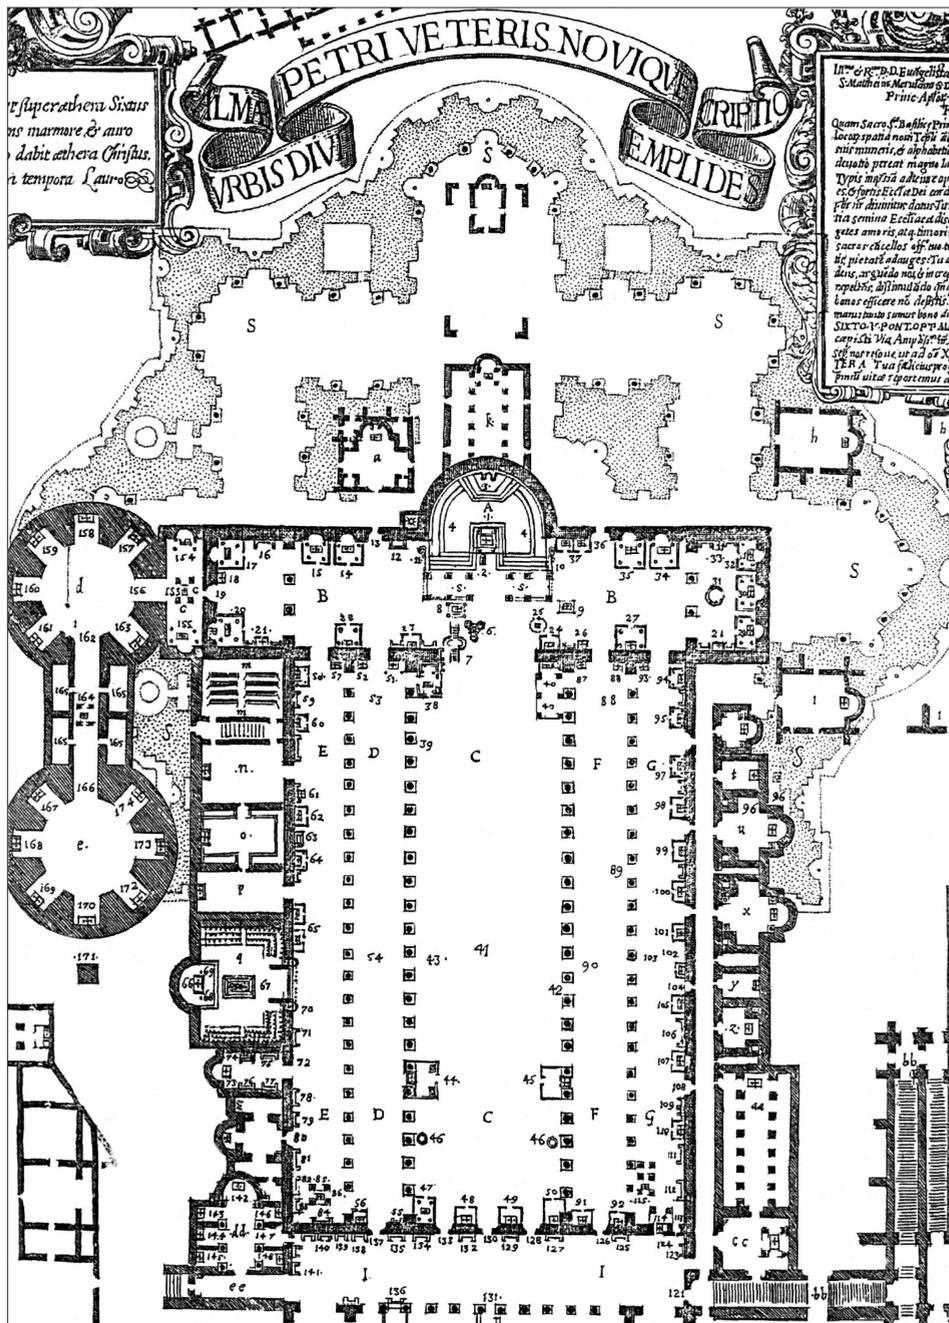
Pianta dell'antica San Pietro (da Alfarano 1590).
